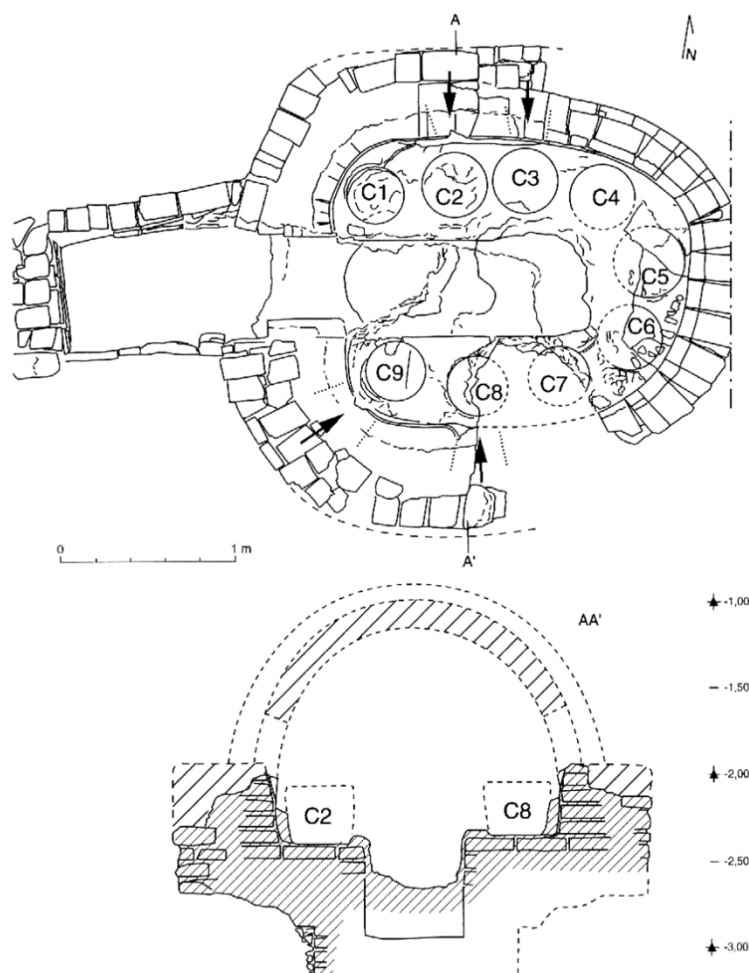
Horno de Belluga/Polo de Medina. Planta y sección. Las flechas de la planta indican las aberturas sobre la banqueta para extraer el vidrio de los crisoles
